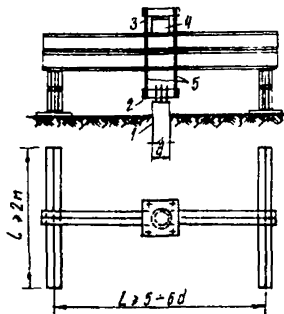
Схема установки для испытания свай на действие вертикальной выдергивающей нагрузки:
